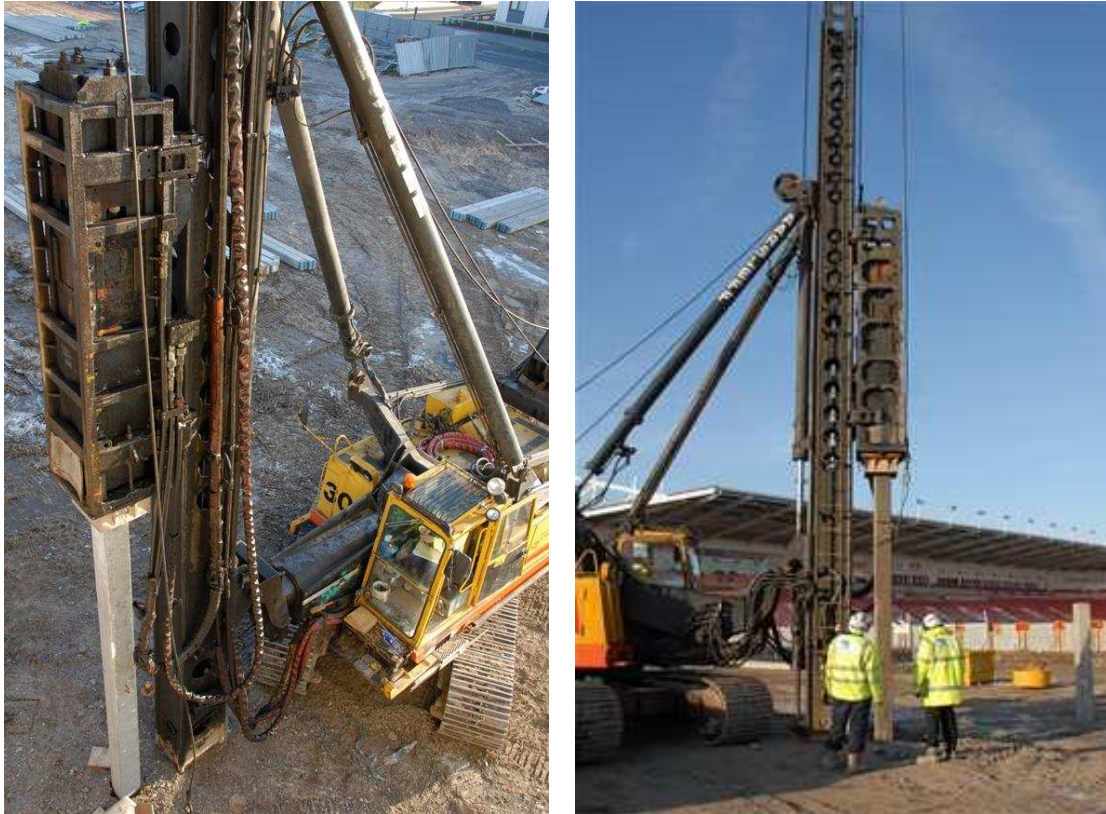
Exemplo de cravação de estaca pré fabricada de betão armado (Construction news, 2009).
